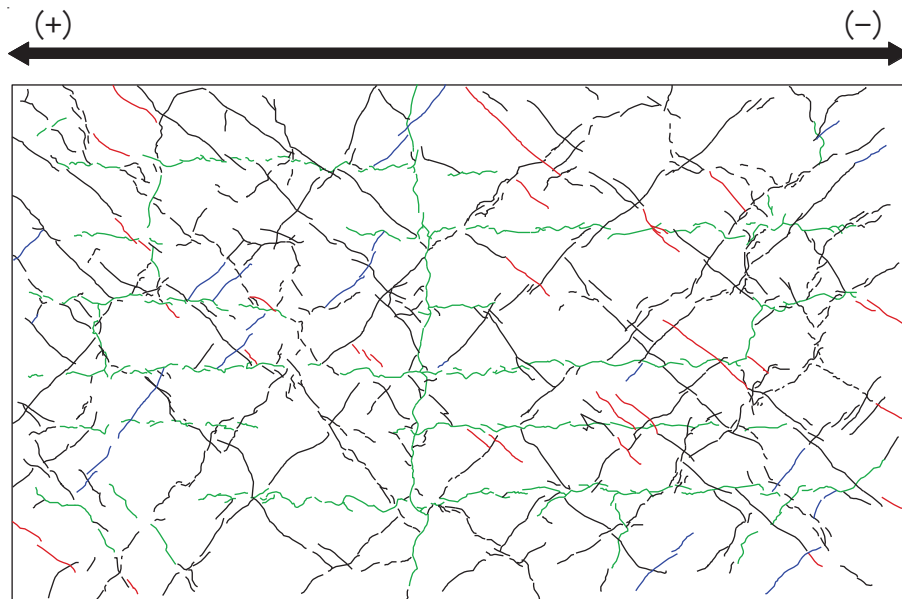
(10) 乾燥試験体 [1] 1/333rad. におけるひび割れ図
